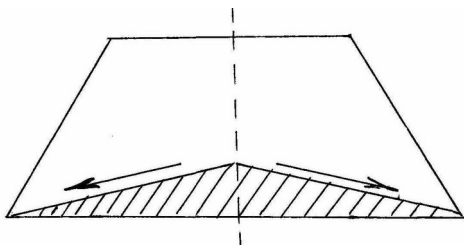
Схема отсыпки насыпи наклонными слоями поперечный («с головы»)
